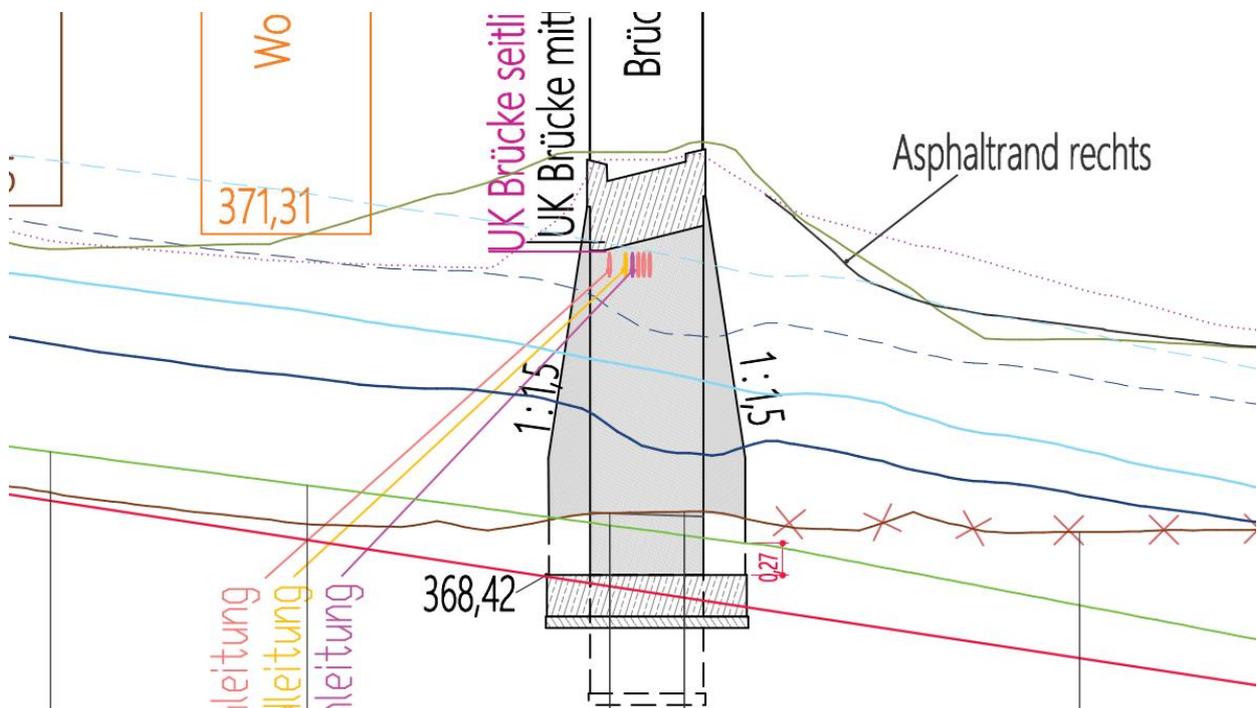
Längsschnitt Bereich Brücke Hauptstraße mit Sohleintiefungsvarianten (Grün: reduzierte Sohleintiefung)
